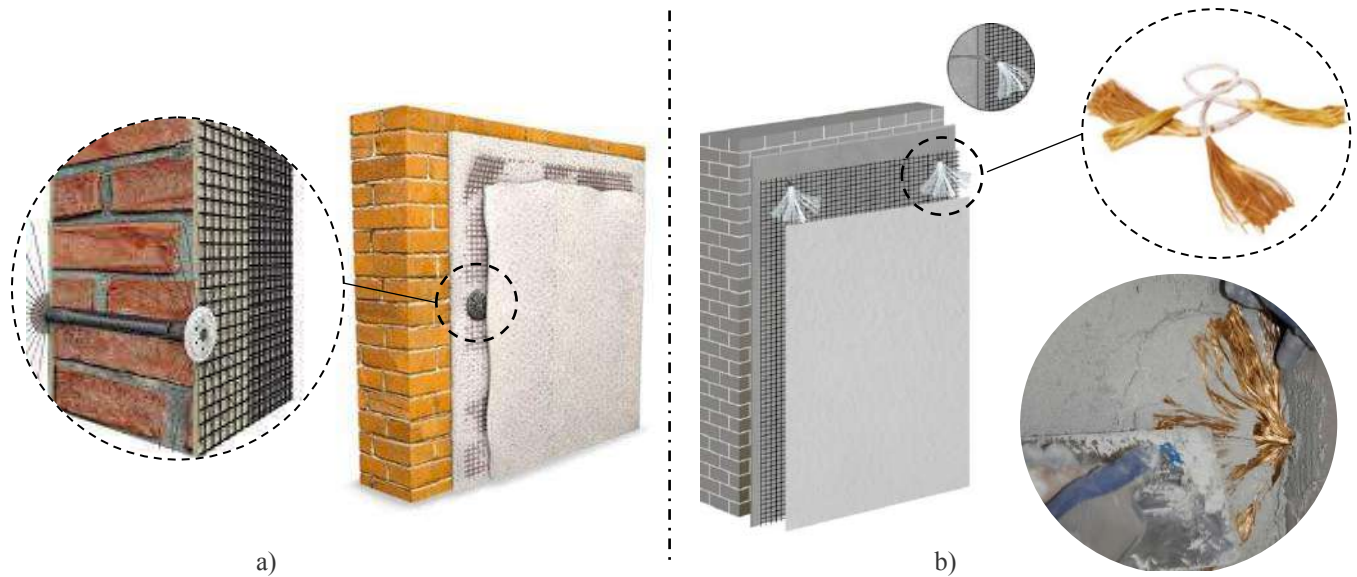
Application du FRCM application : système d'ancrage (connecteur).
